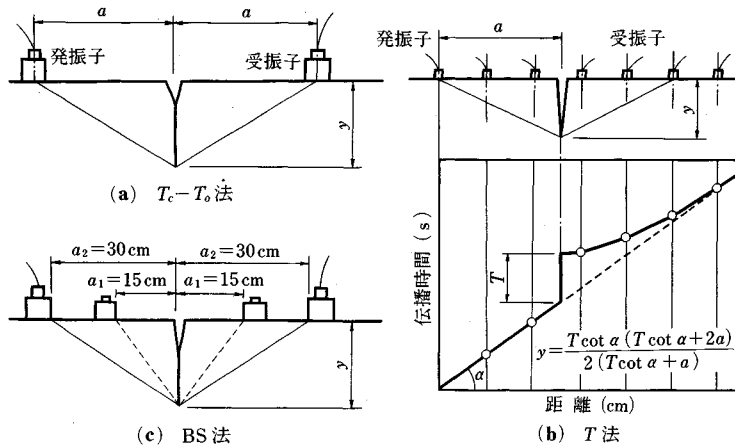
コンクリートでの超音波法によるひび割れ深さ測定
